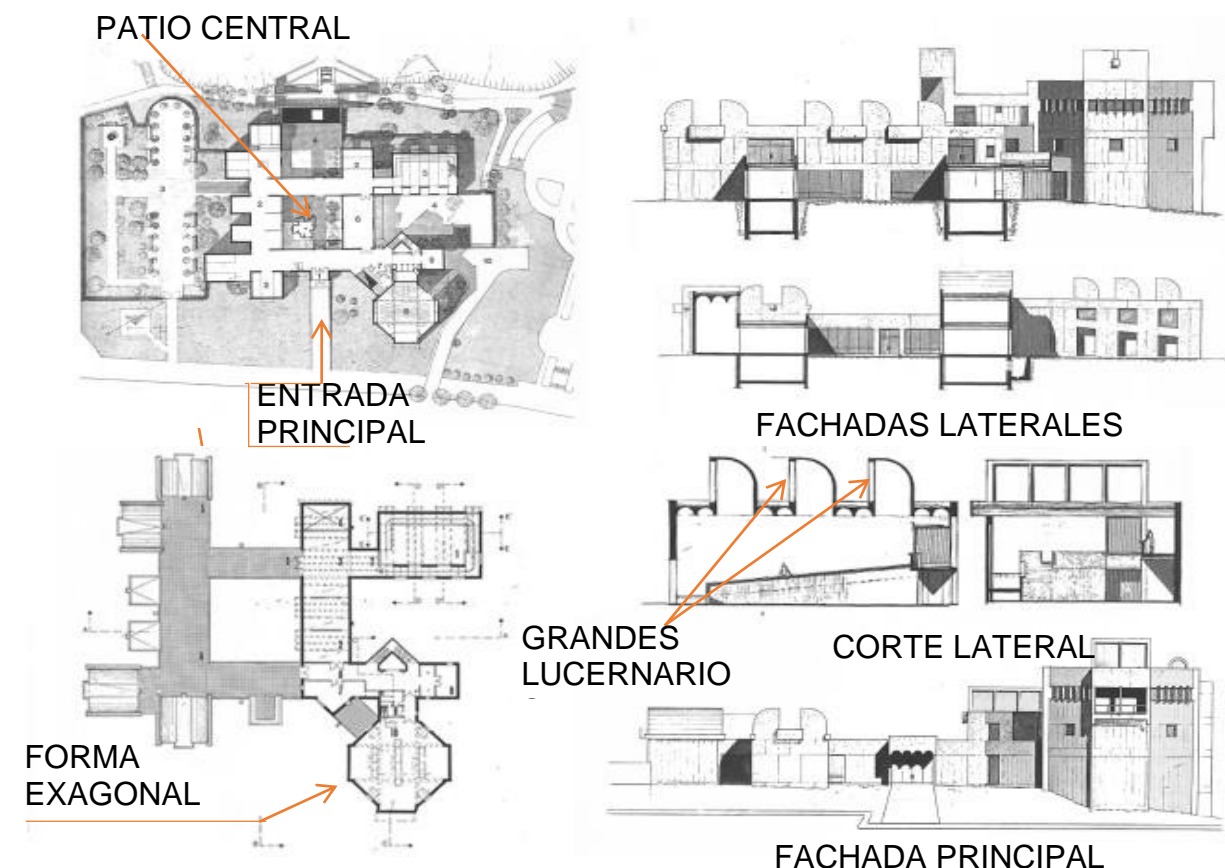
Alzado de Plantas y Elevación del Museo Joan Miro
